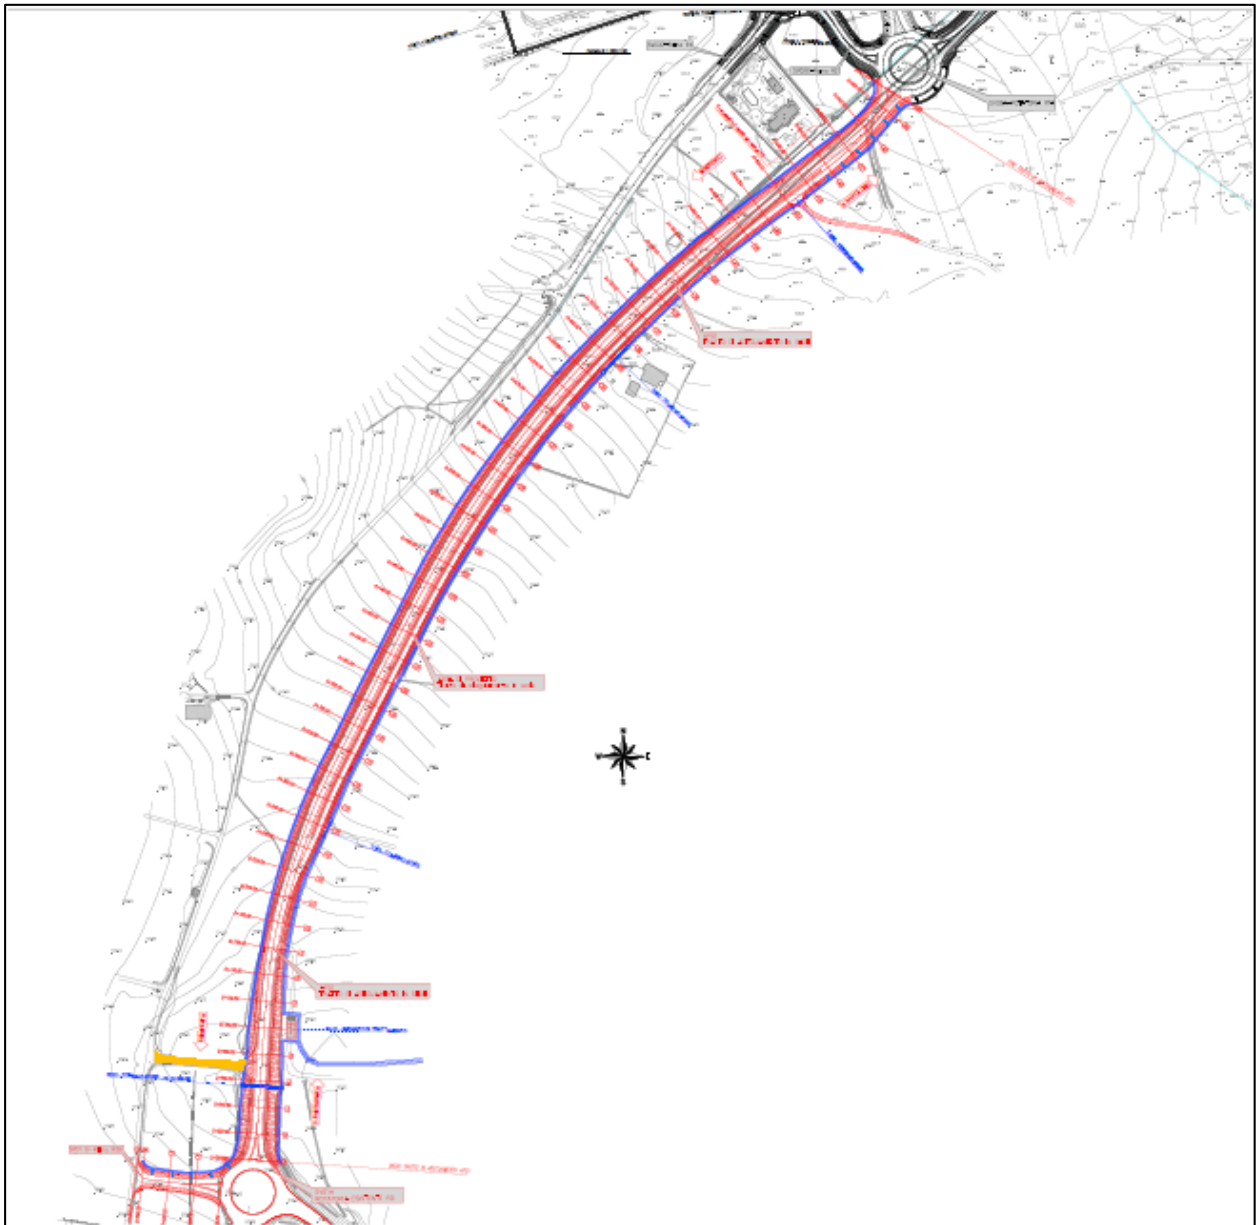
Planimetria di progetto Tratto di adeguamento in sede
